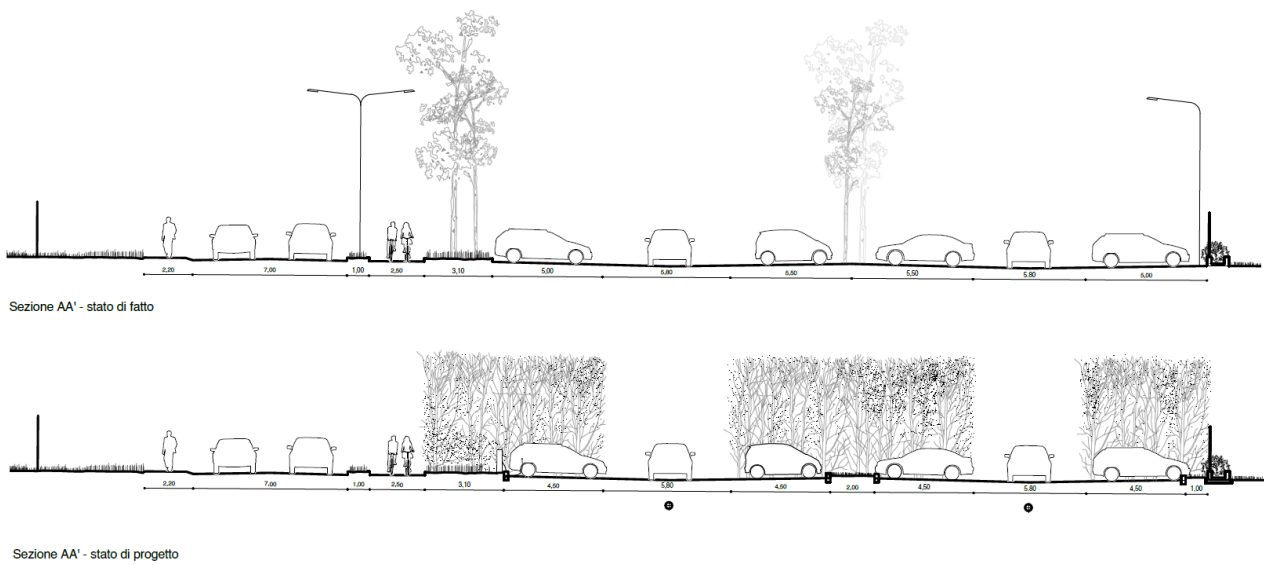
Confronto tra stato di fatto e progetto (in sezione)
